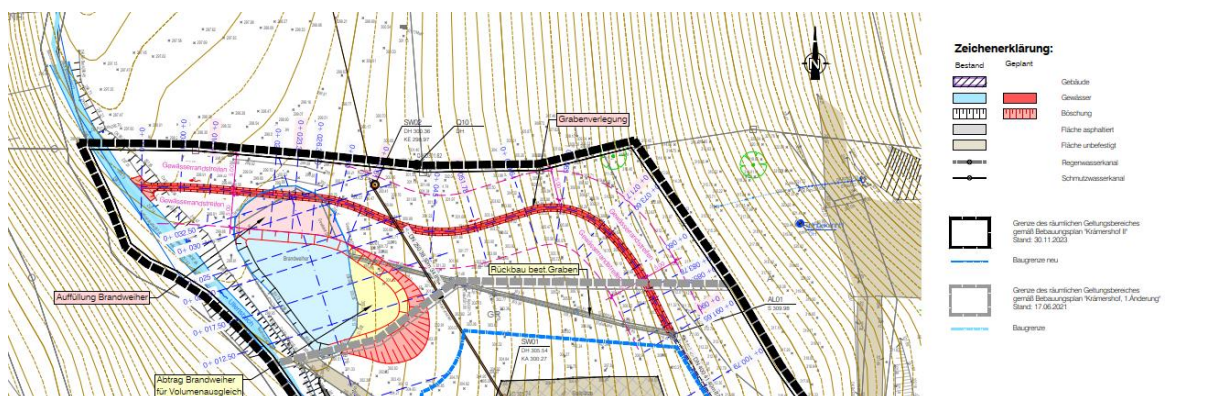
Auszug aus dem Lageplan der Planung zur Verlegung des Gewässergrabens im nördlichen Bereich des Plangebiets; Quelle: Zink Ingenieure GmbH, eigene Darstellung
